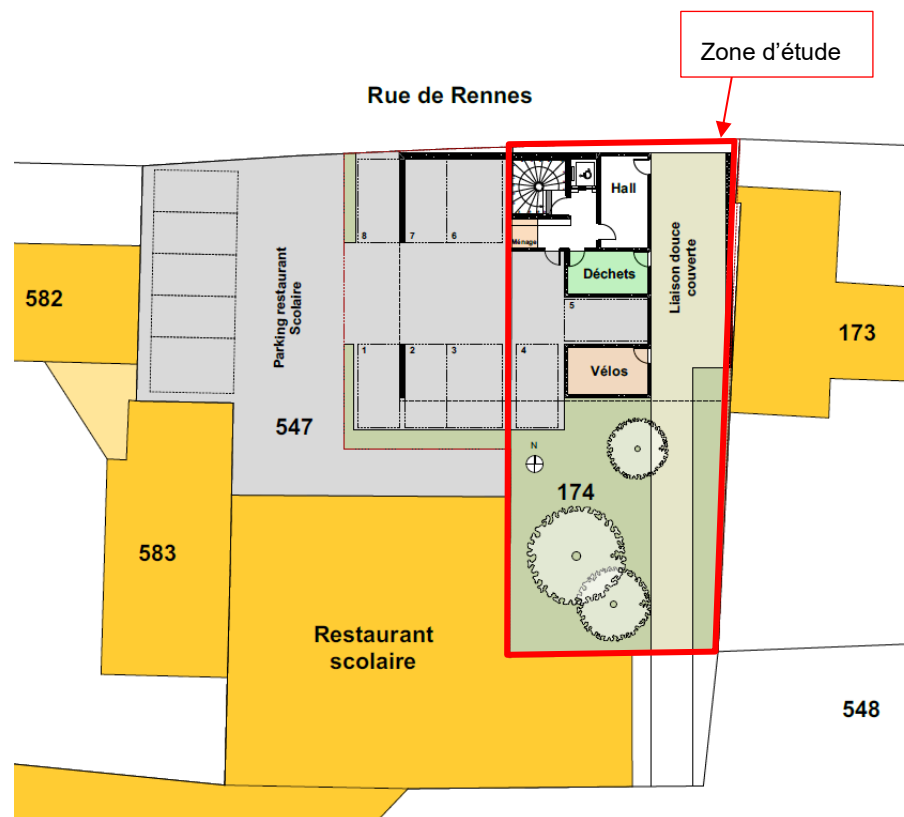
Plan du projet transmis par l'EPF (30/11/2023)
